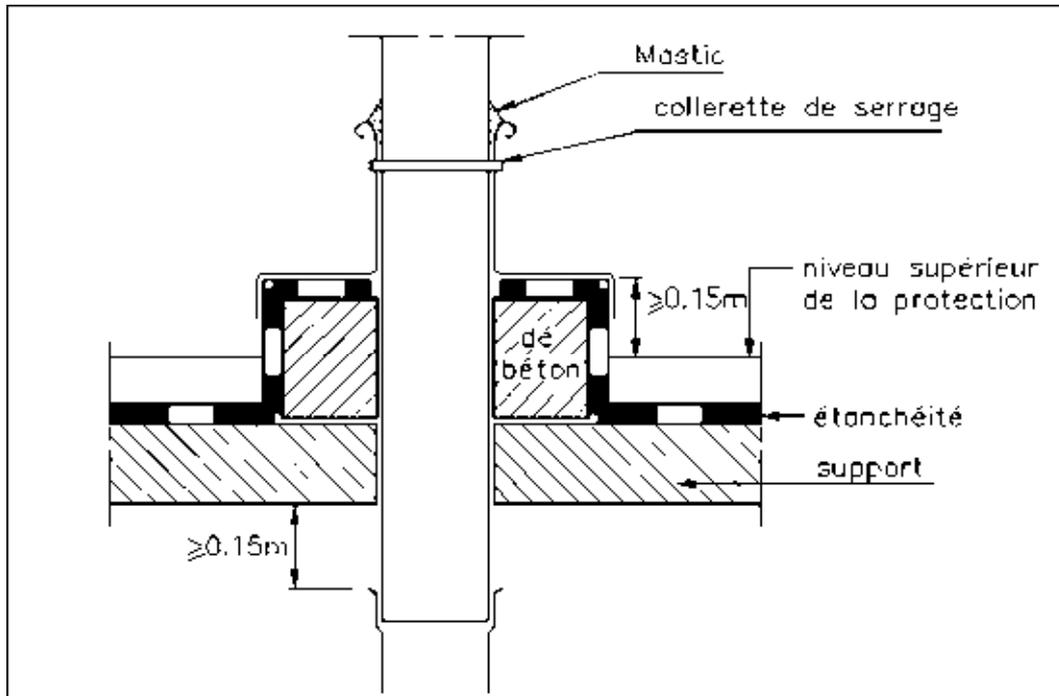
Canalisations de ventilation/tuyau non traversant : raccordement par fourreau et platine en plomb
